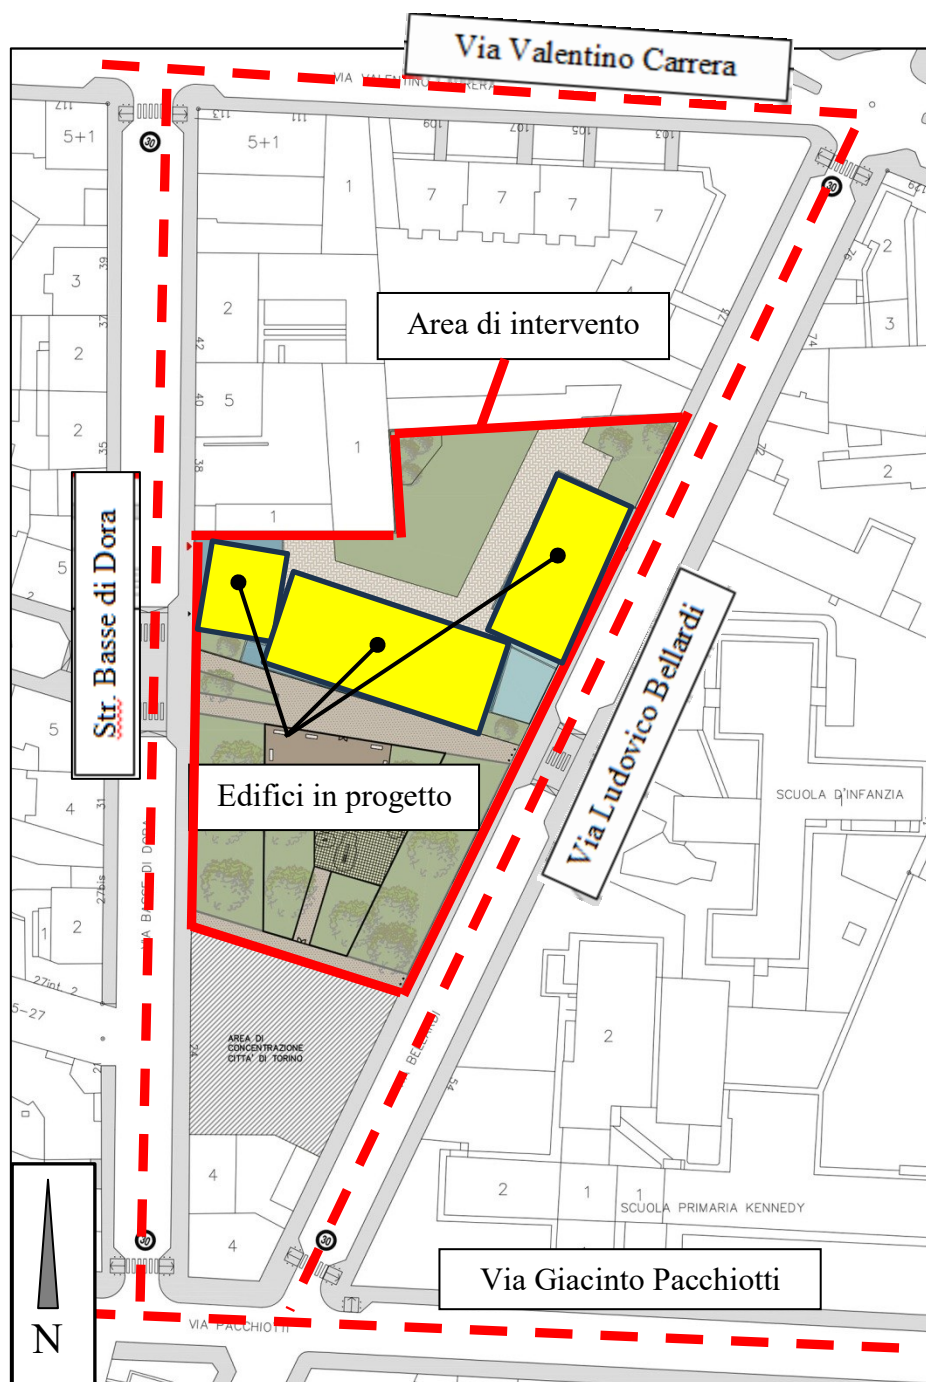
Elaborato planimetrico area di intervento e sagoma edifici in progetto
